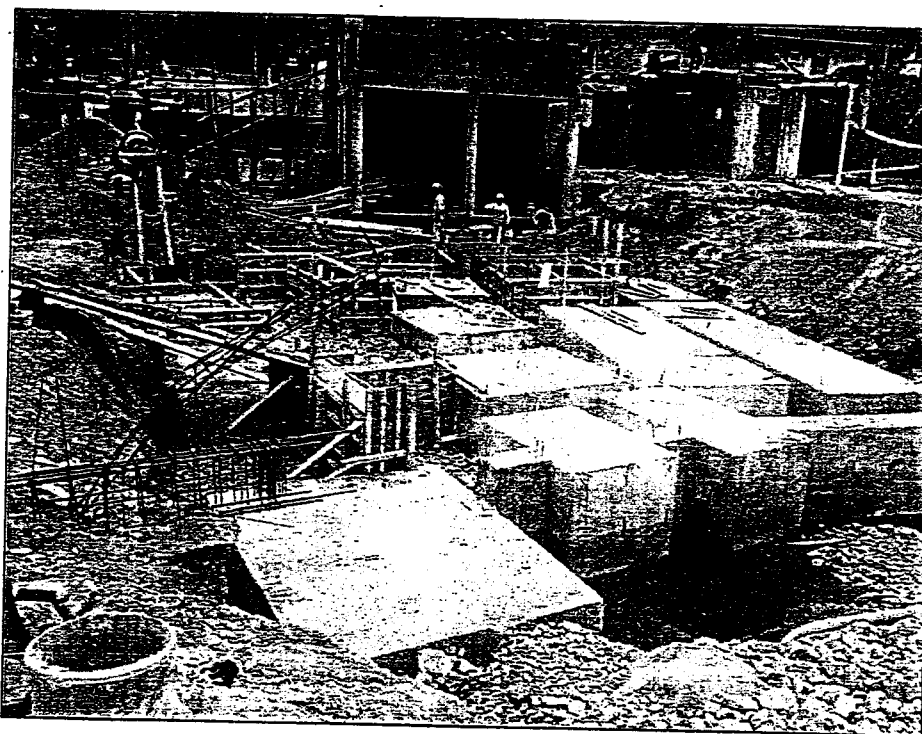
Vista panorámica de las falsas zapatas de la zona de Desinfección y las falsas zapatas que estaban pendientes de vaciar de la zona de Tareas Previas.
